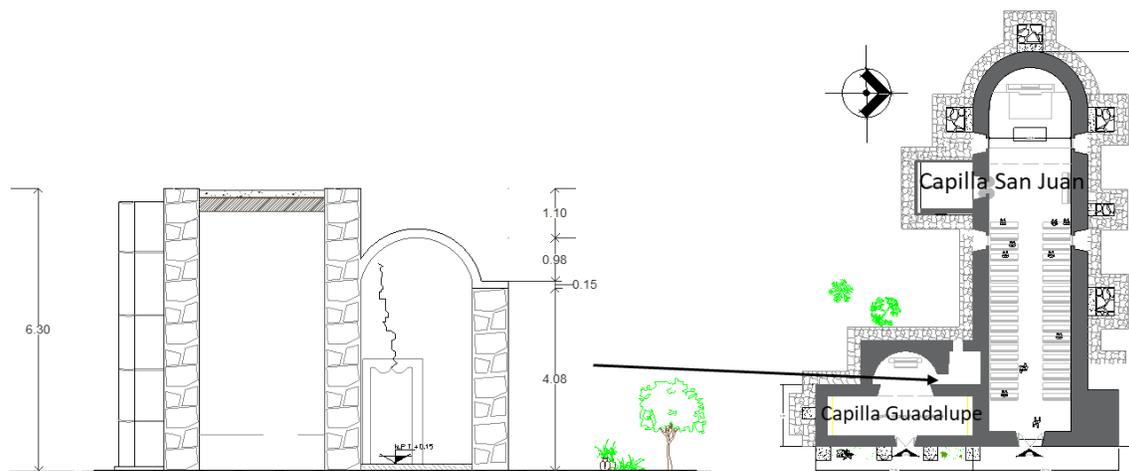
Localización en planta y corte del arco conopial fracturado. Fuente: elaborado por autor
